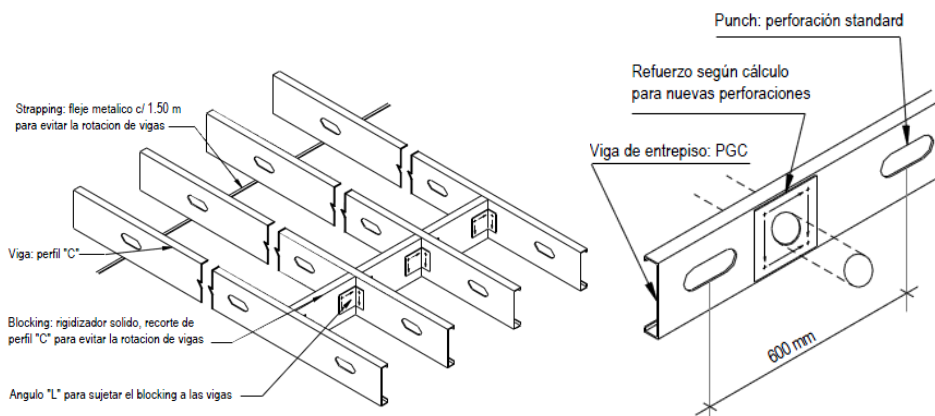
Rigidizadores. (ConsulSteel, 2002).
